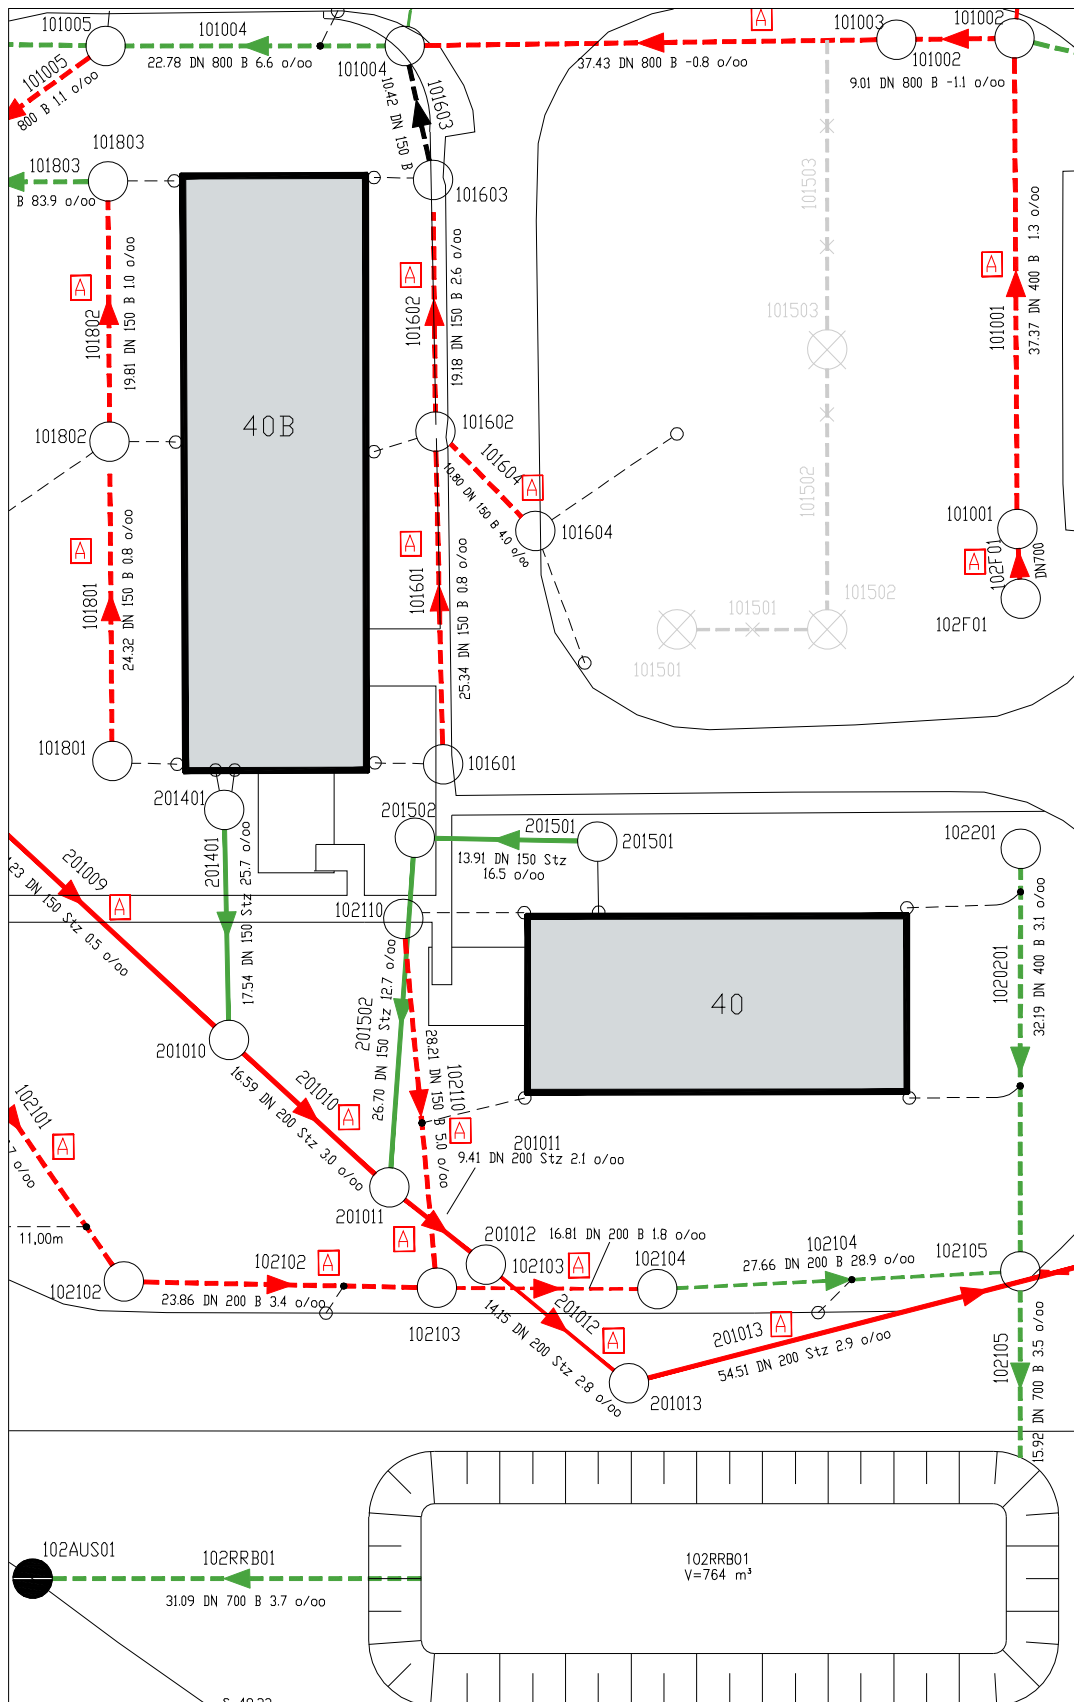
18 Beispielplan: Lageplan „Ablagerungsgefährdete Kanäle“
